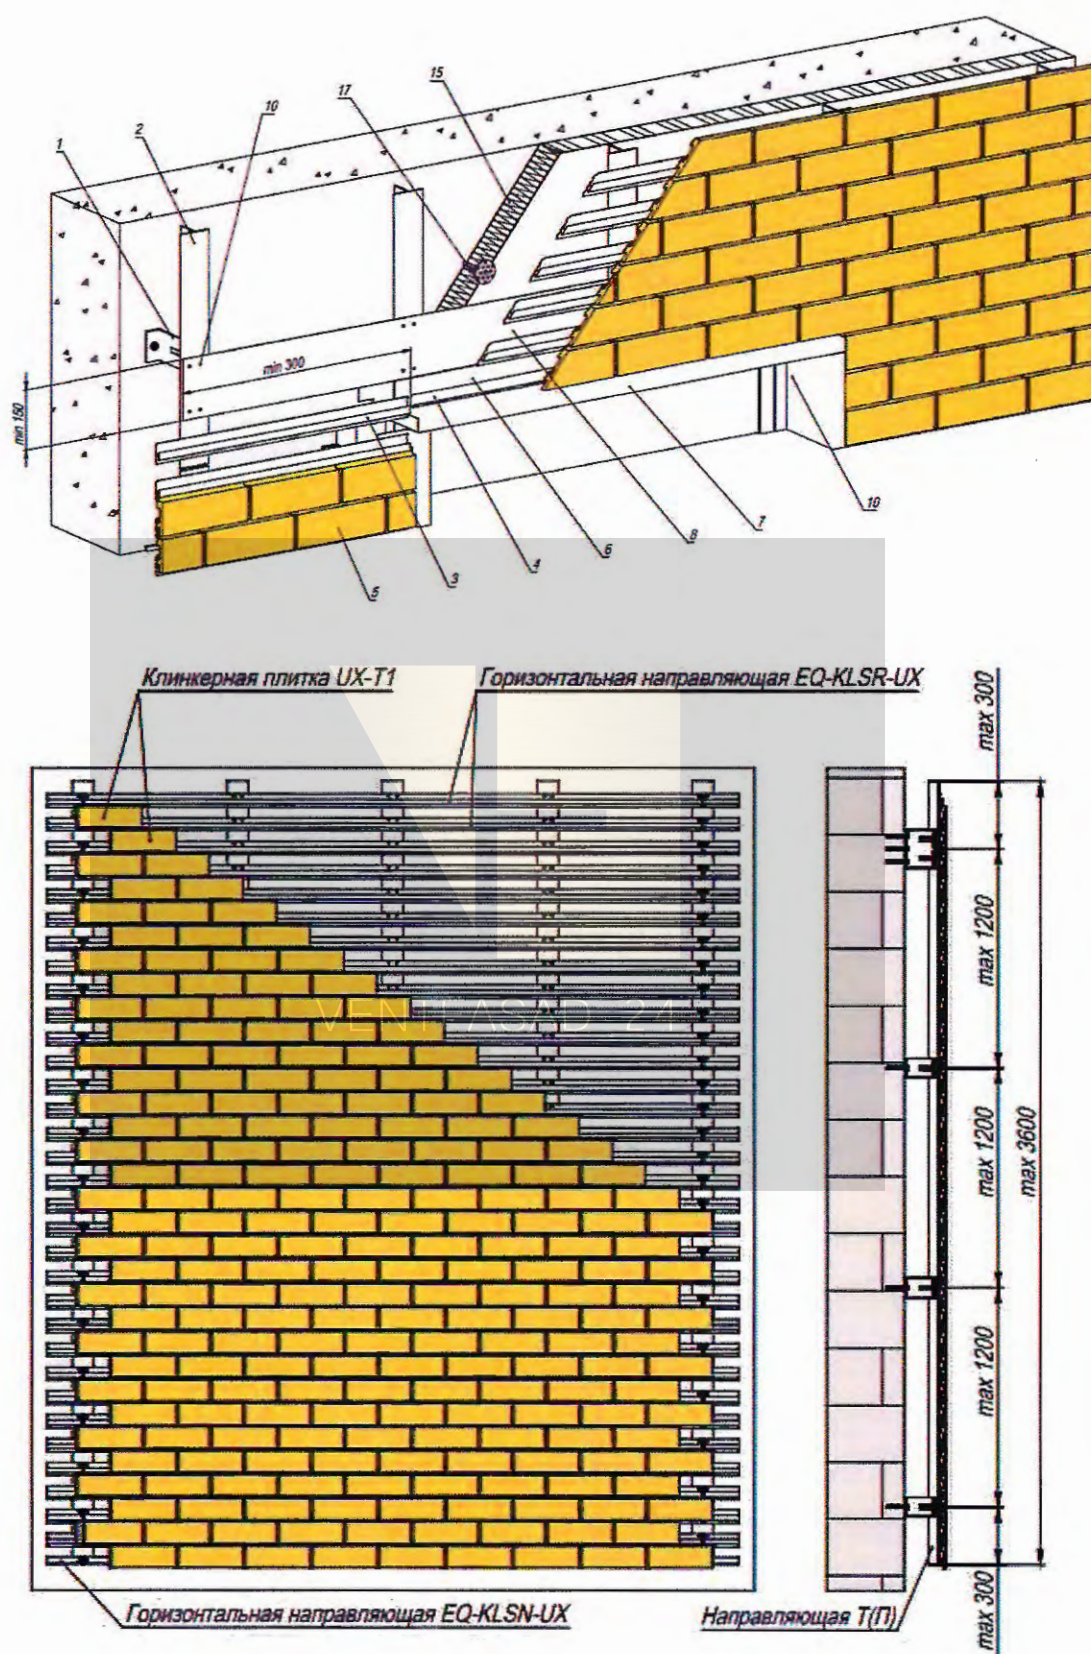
Проектная схема крепления клинкерной плитки с помощью горизонтальных направляющих к стеновому основанию (надоконная и сплошная зоны стен)
